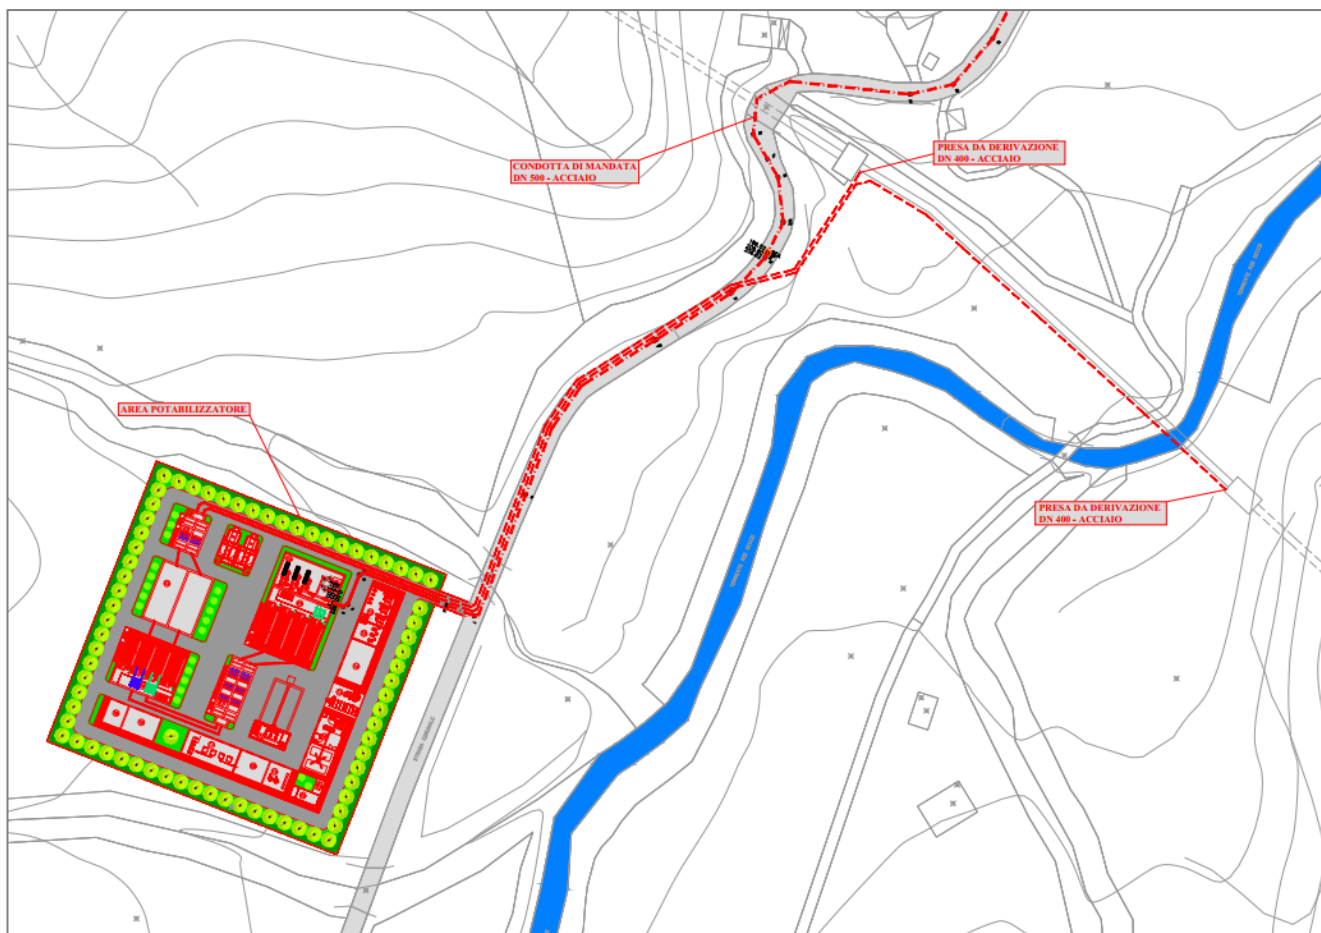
Impianto di potabilizzazione – planimetria di progetto
